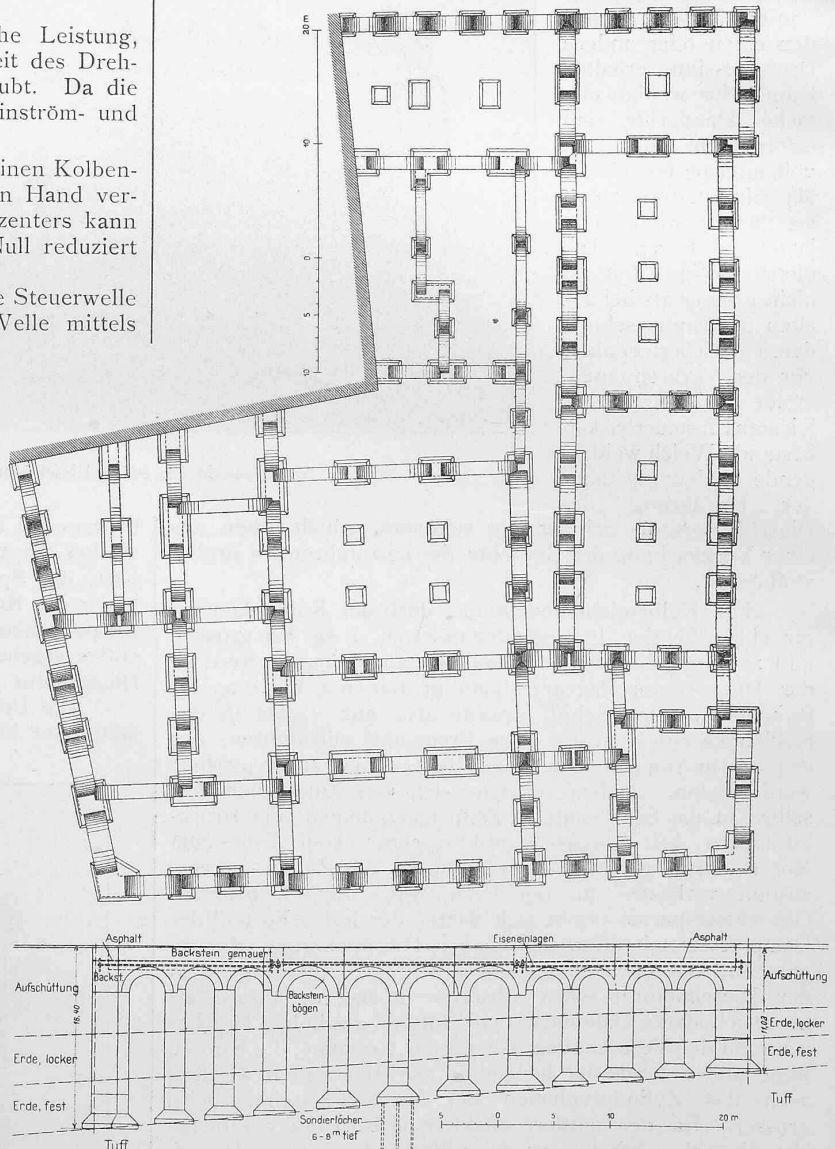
und 19. Grundriss und Aufriss der Fundamente. — Masstab 1 : 600.
